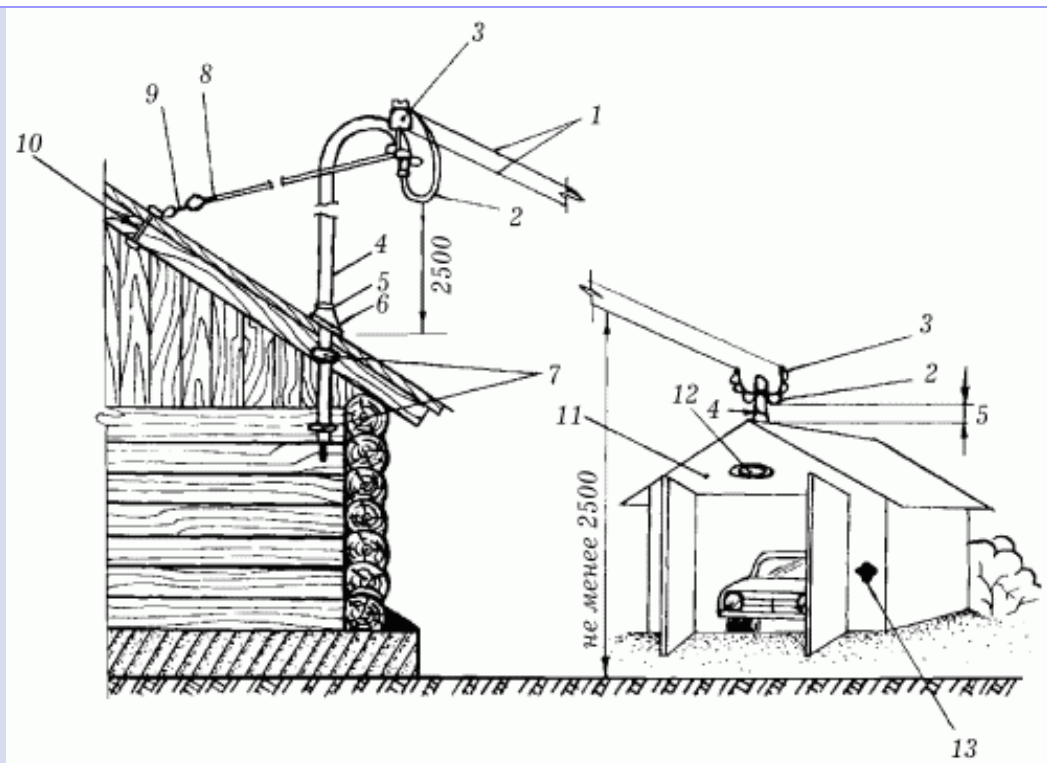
Прокладка проводов из здания в гараж: 1 – провода ответвления; 2 – провод ввода в помещение; 3 – изолятор фарфоровый; 4 – трубостойка; 5 – кольцо опорное, приваренное к трубостойке; 6 – «копыто», свободно надетое на трубостойку; 7 – скобы металлические; 8 – растяжка; 9 – струбина; 10 – болт-шпилька; 11 – гараж; 12 – электросветильник типа ПСХ-60; 13 – выключатель полугерметический.
